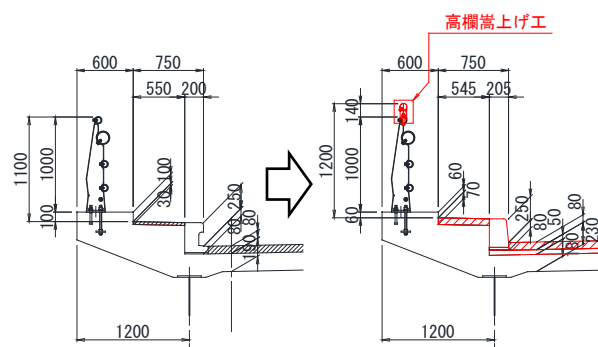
防護柵嵩上げ（左：施工前、右：施工後）
